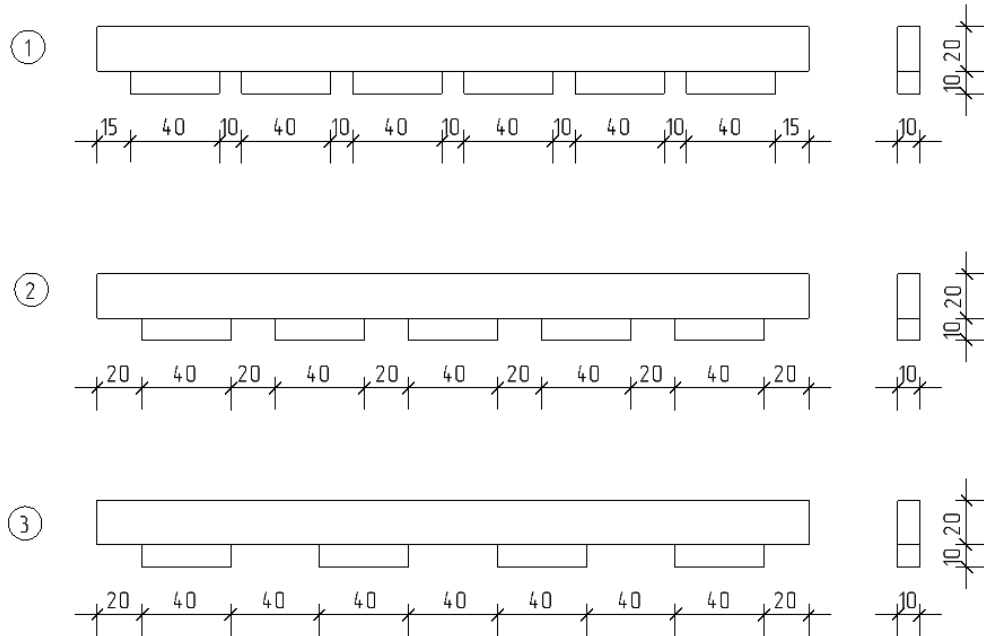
Моделі переривчастих фундаментів: 1 – крок між фундаментними плитами 10 мм; 2 – крок між фундаментними плитами 20 мм; 3 – крок між фундаментними плитами 40 мм.
